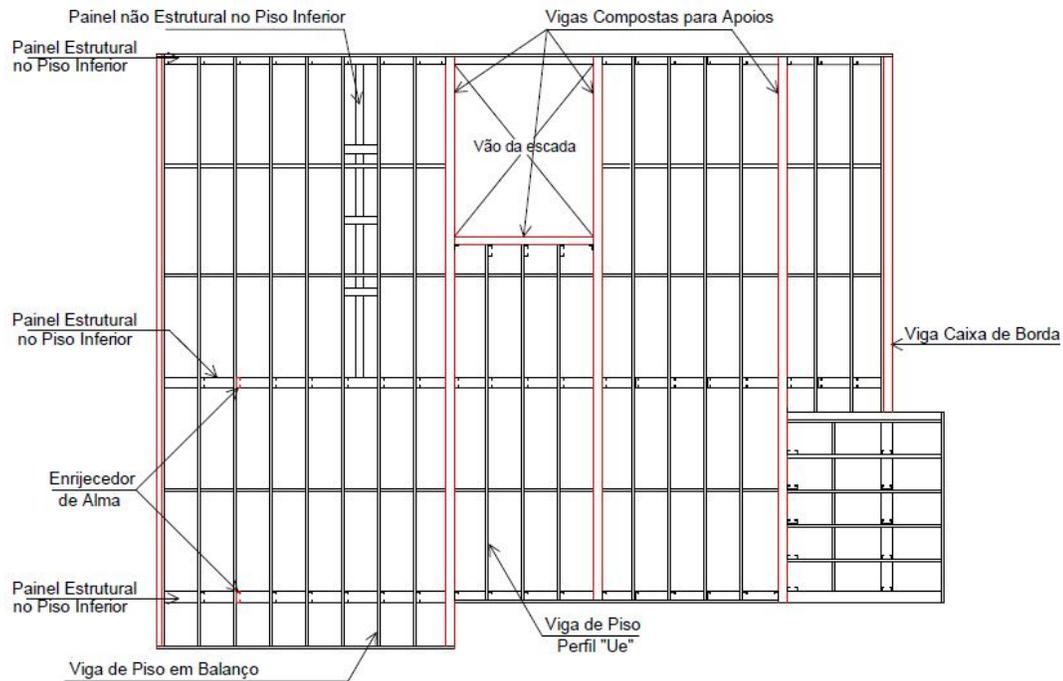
Esquema estrutural de uma laje em LSF (Adaptado de FREITAS; CRASTO, 2006)
